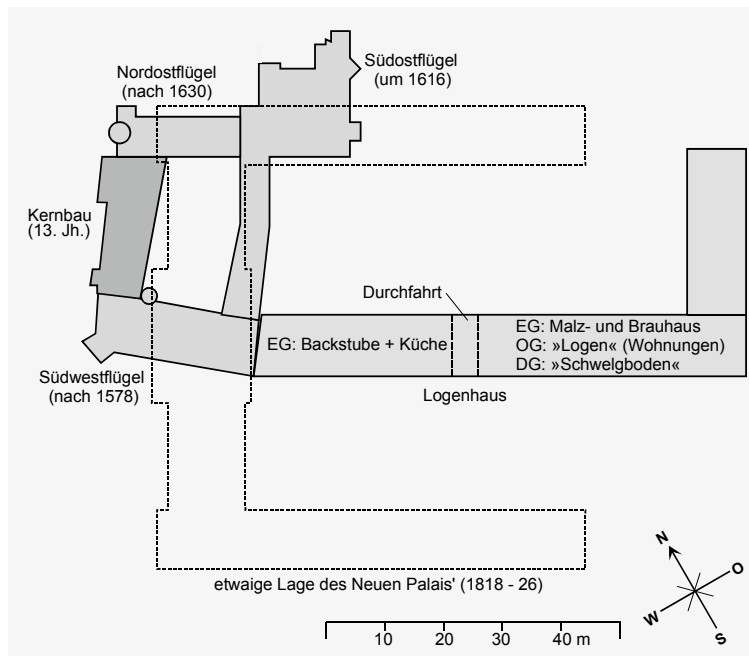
Grundriss des alten (1818 abgebrannten) Schlosses Pillnitz.
